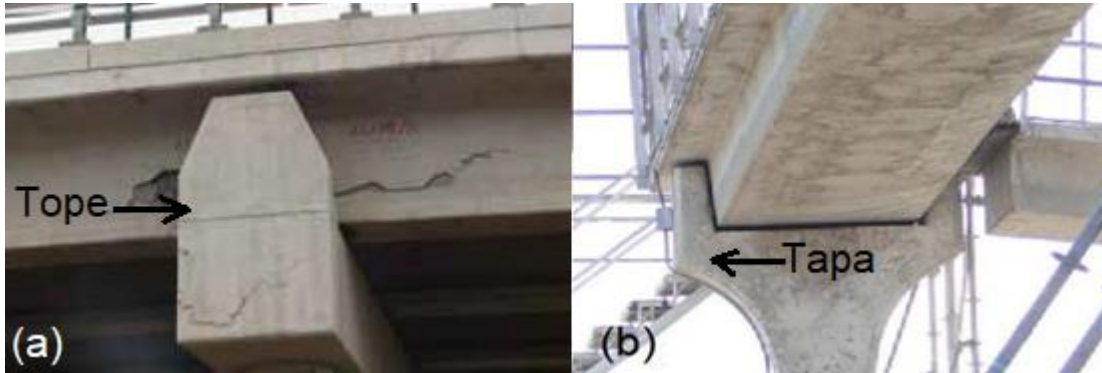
Puente (a) topes laterales de Hormigón armado, (b) tapa de Hormigón armado. [2]
